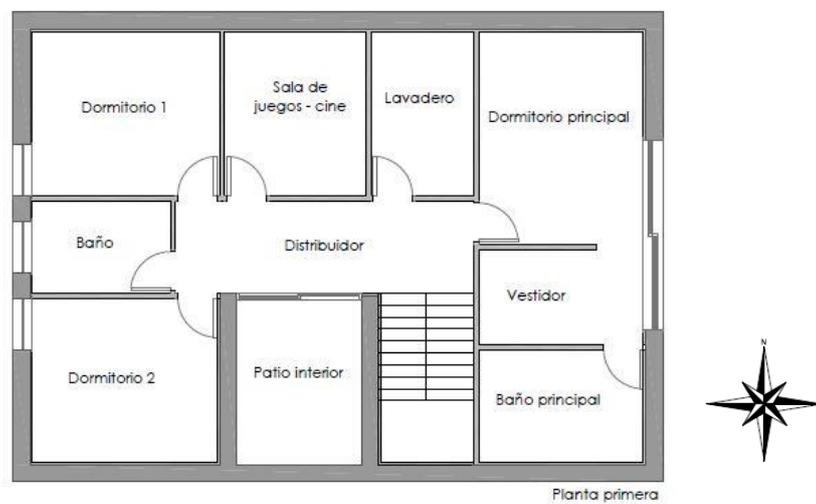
Planta primera. Fuente: Elaboración propia.
